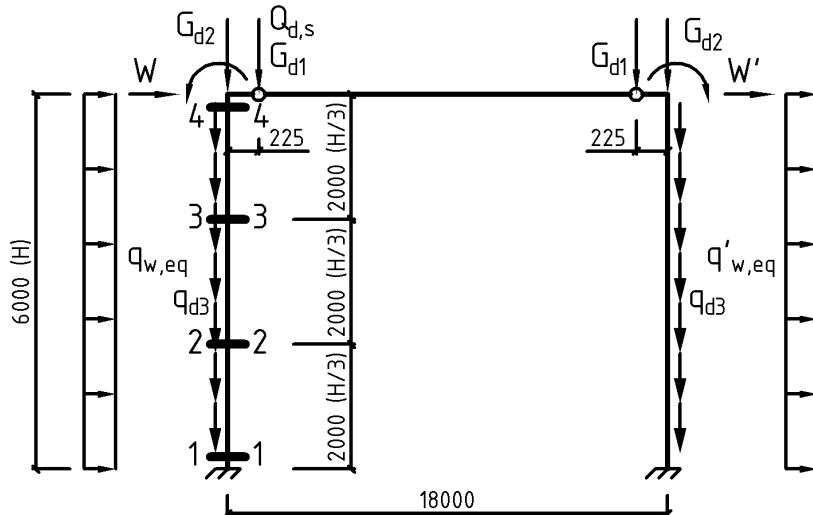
Расчетная схема поперечной рамы ОПЗ
